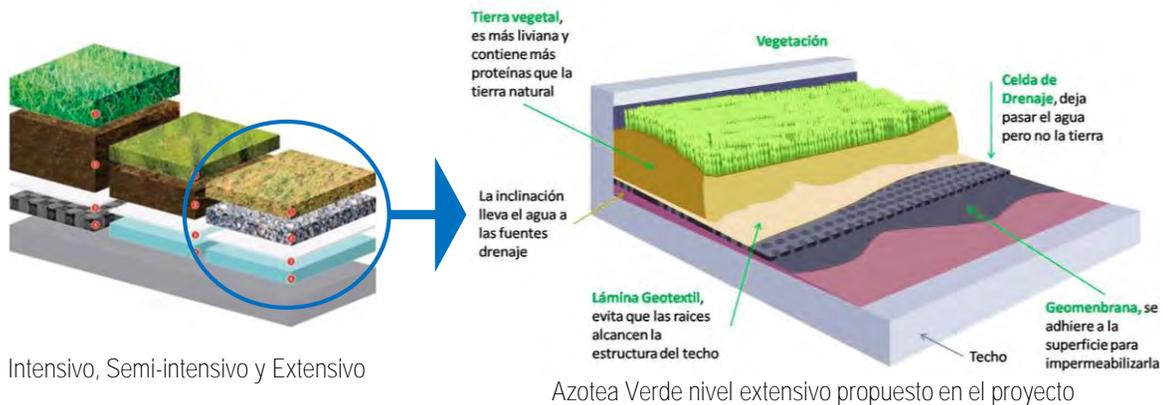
Niveles de azoteas verdes y detalle constructivo de azotea verde nivel extensivo
